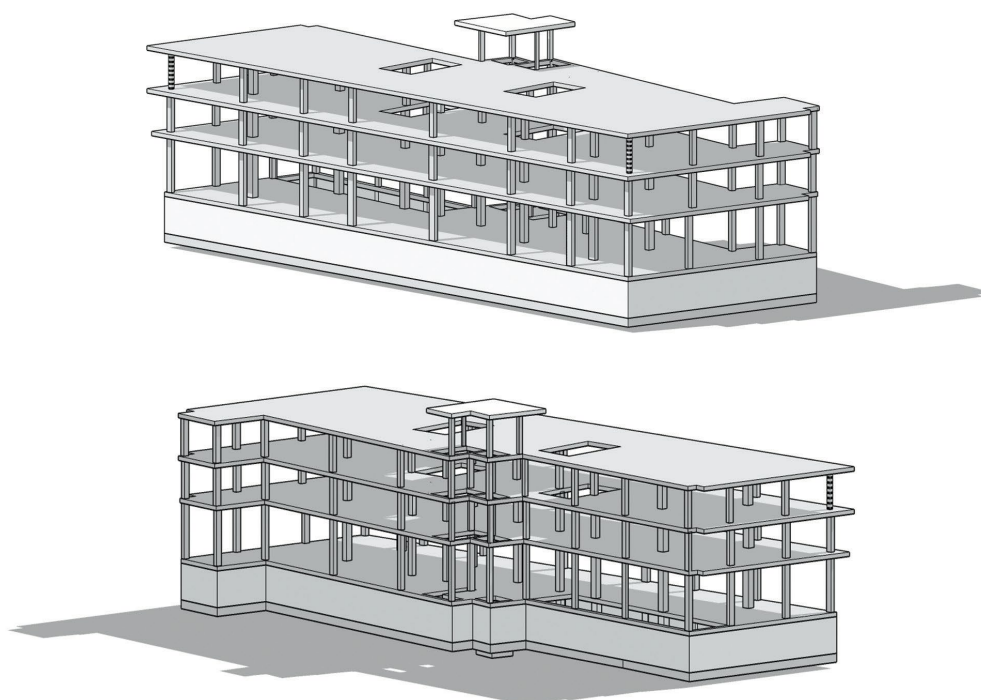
Perspectivas de la estructura del edificio del ejemplo.
